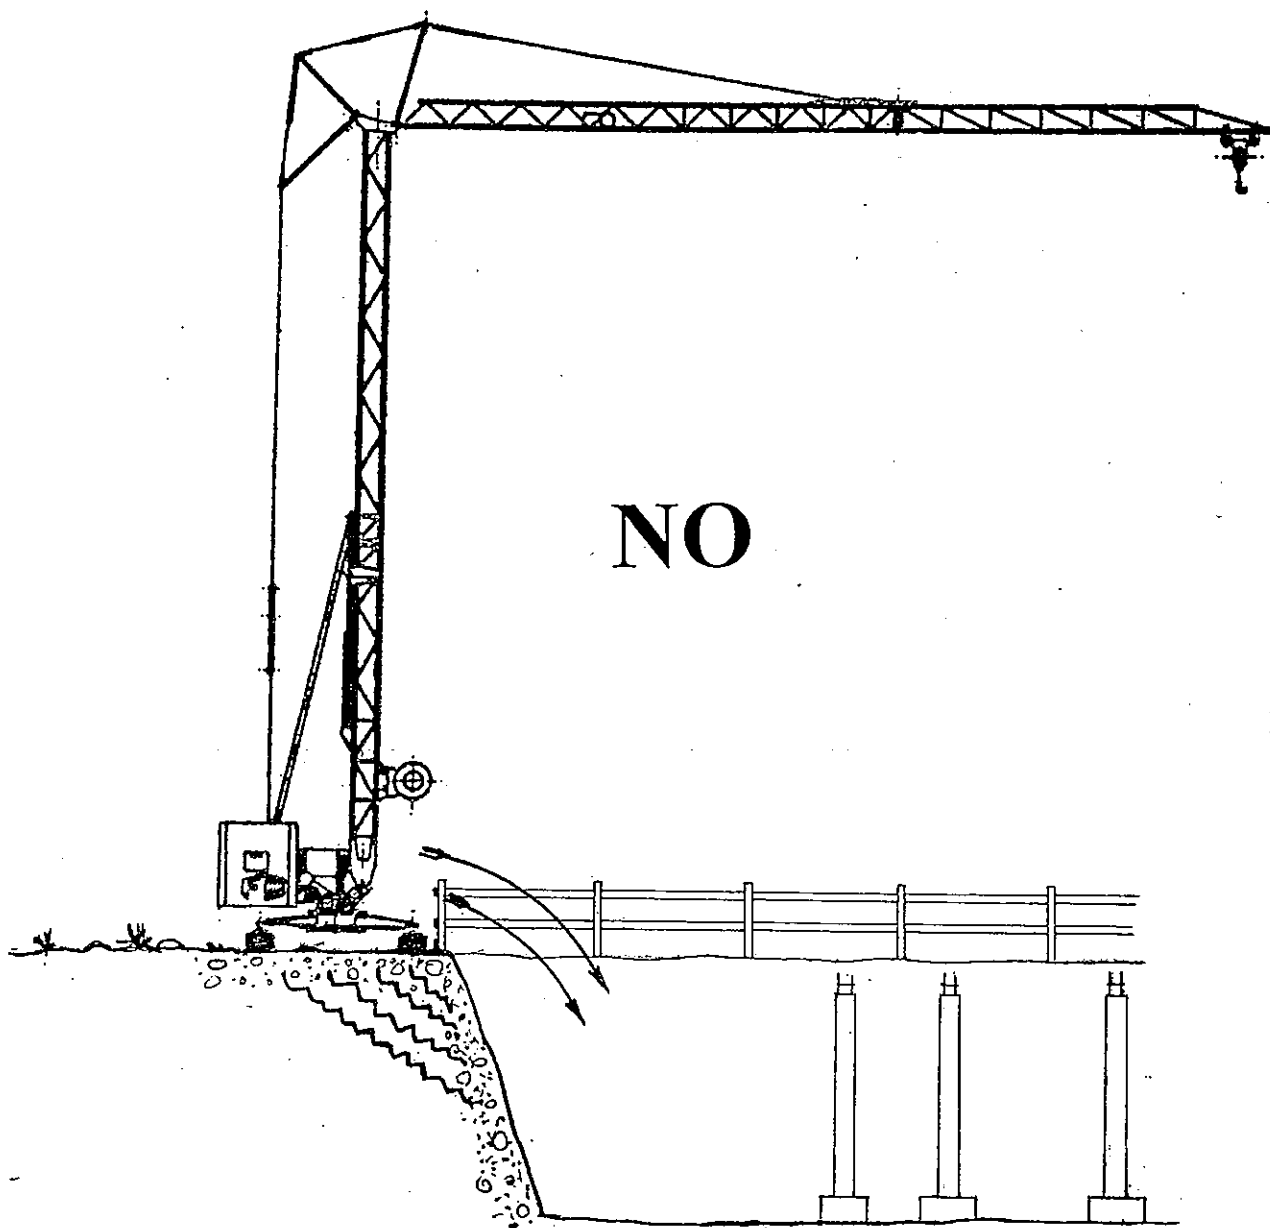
INSTALLAZIONE PERICOLOSA DELLA GRU
